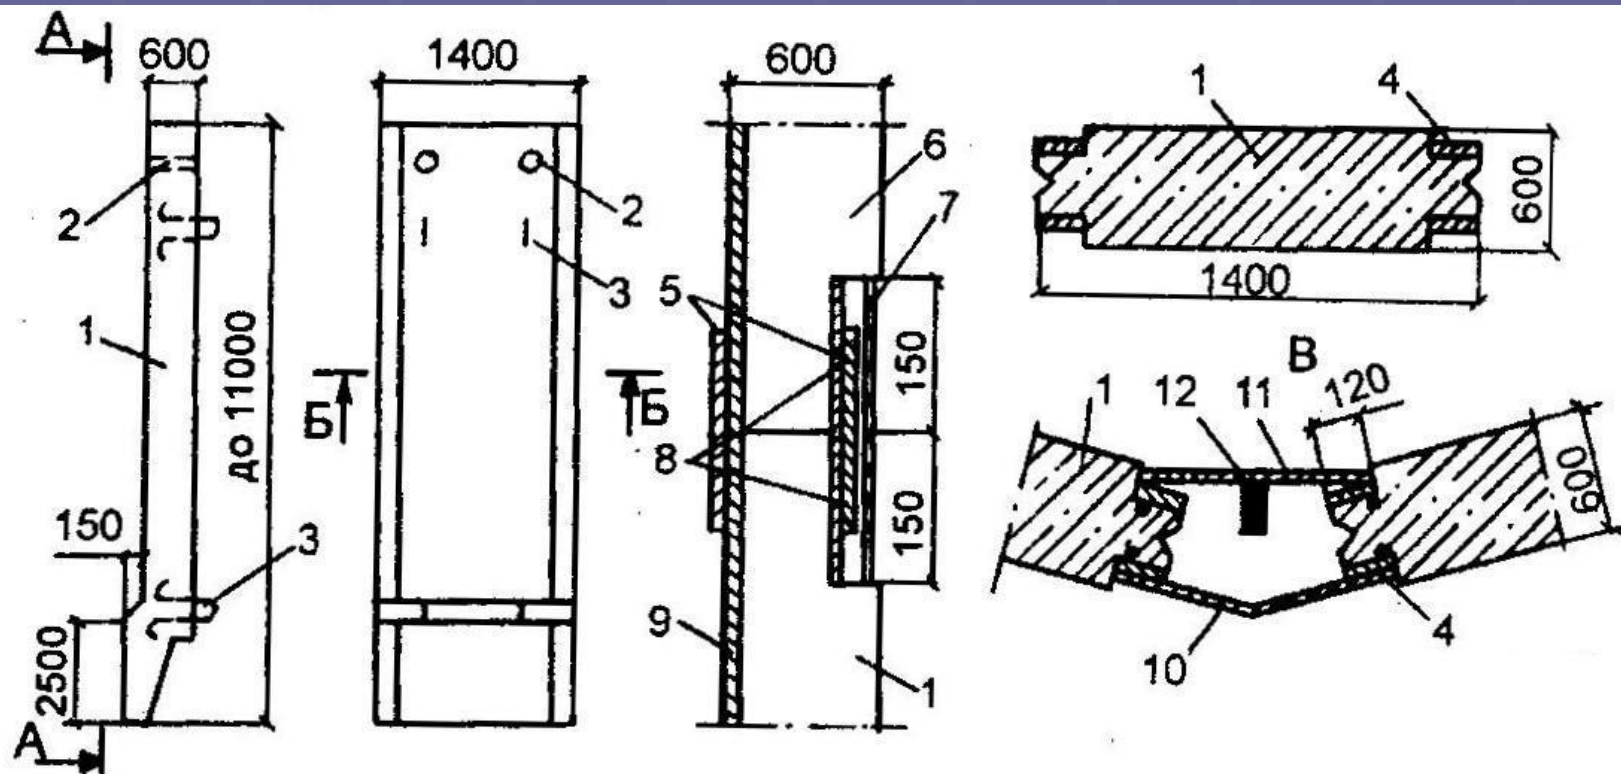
Конструкция железобетонных панелей для стен опускных колодцев и схемы их сопряжения:
